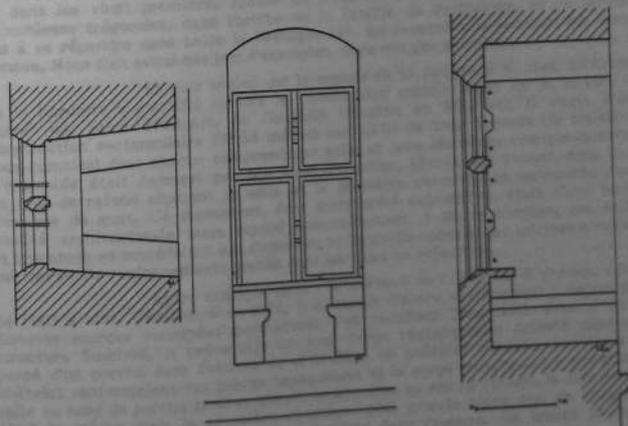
Elven. Donjon. Fenêtre de la salle nord-ouest du premier étage.
